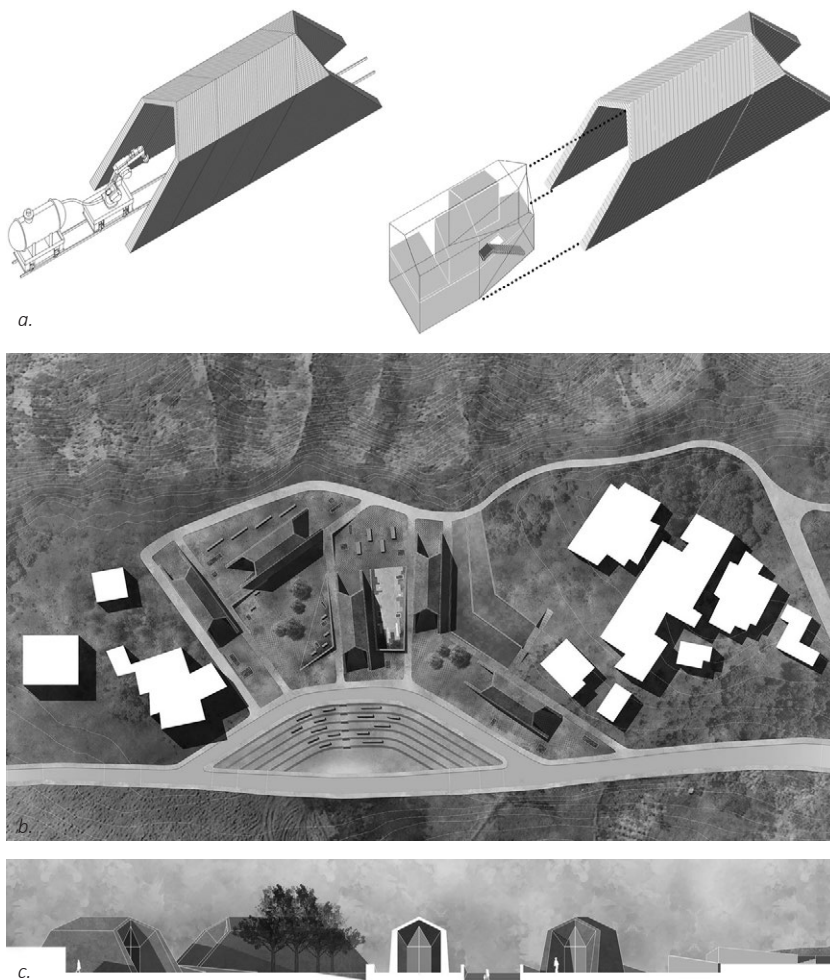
a. Assonometria del progetto in fase di stampa e con inserimento dell'allestimento funzionale; b. Planimetria generale di progetto; c. Sezione territoriale di progetto.
